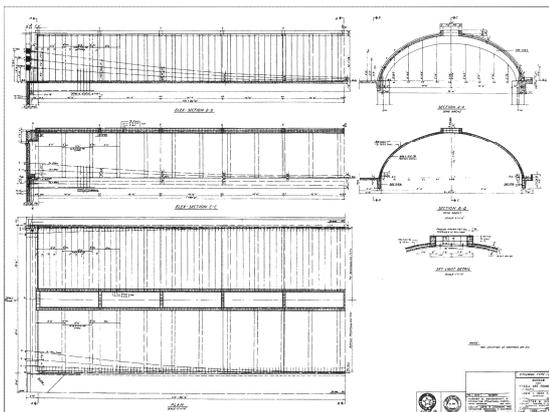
(izq). Secciones constructivas del armado de las bóvedas del Museo Kimbell.
